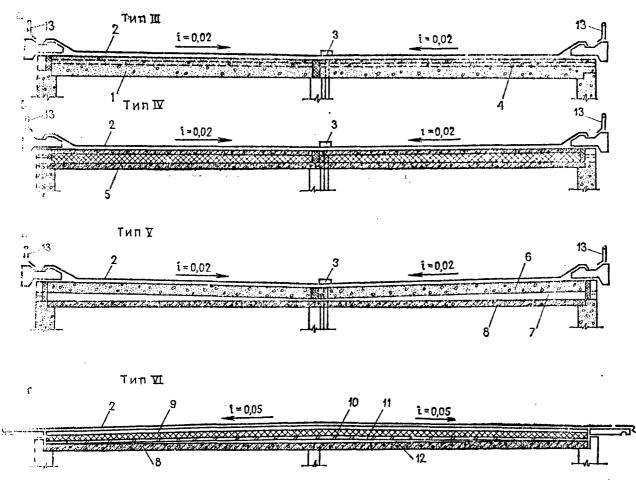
Принципнальные схемы бесчердачных сборных железобетонных совмещенных покрытий (крыш)
